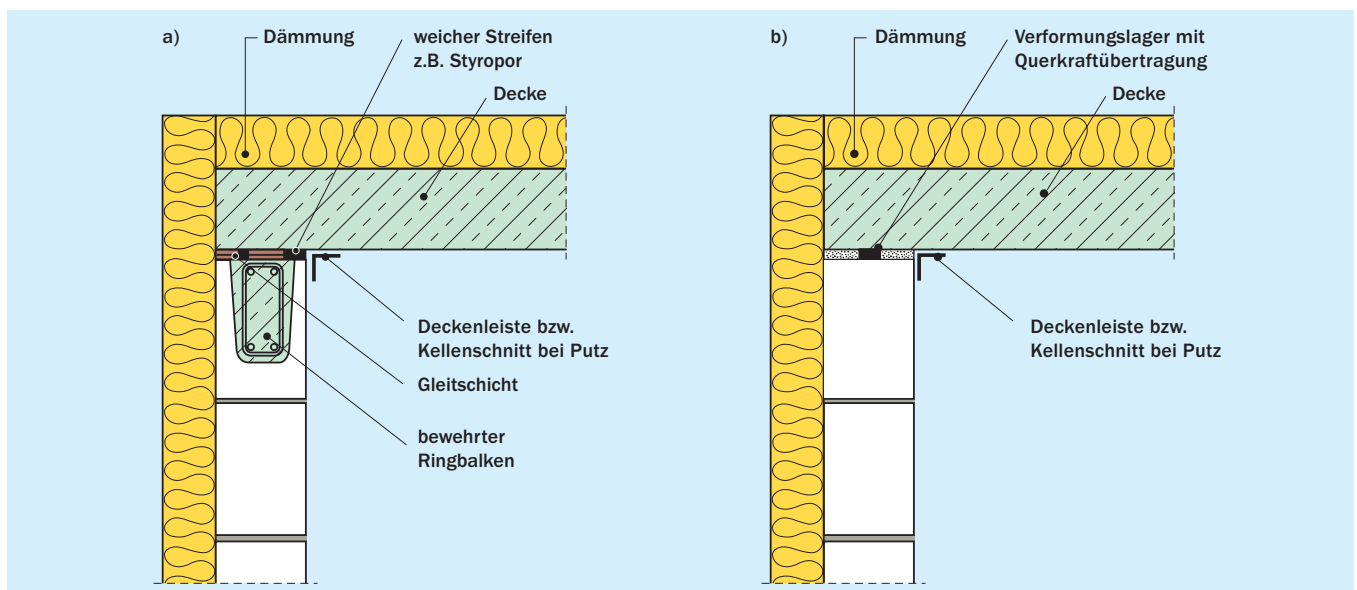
Konstruktive Maßnahmen zur Zentrierung der Deckenauflegerkraft am Beispiel der Außenwand unter einer Dachdecke
